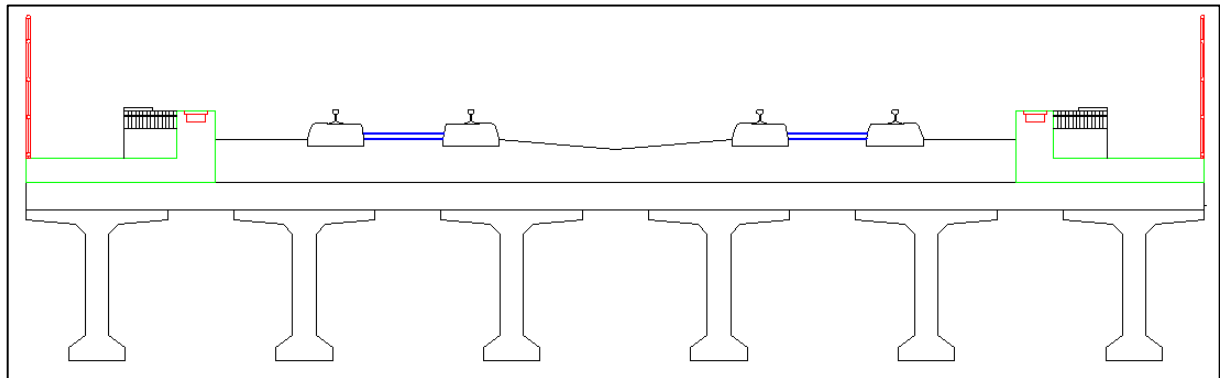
Profil en travers de la variante en béton précontraint
